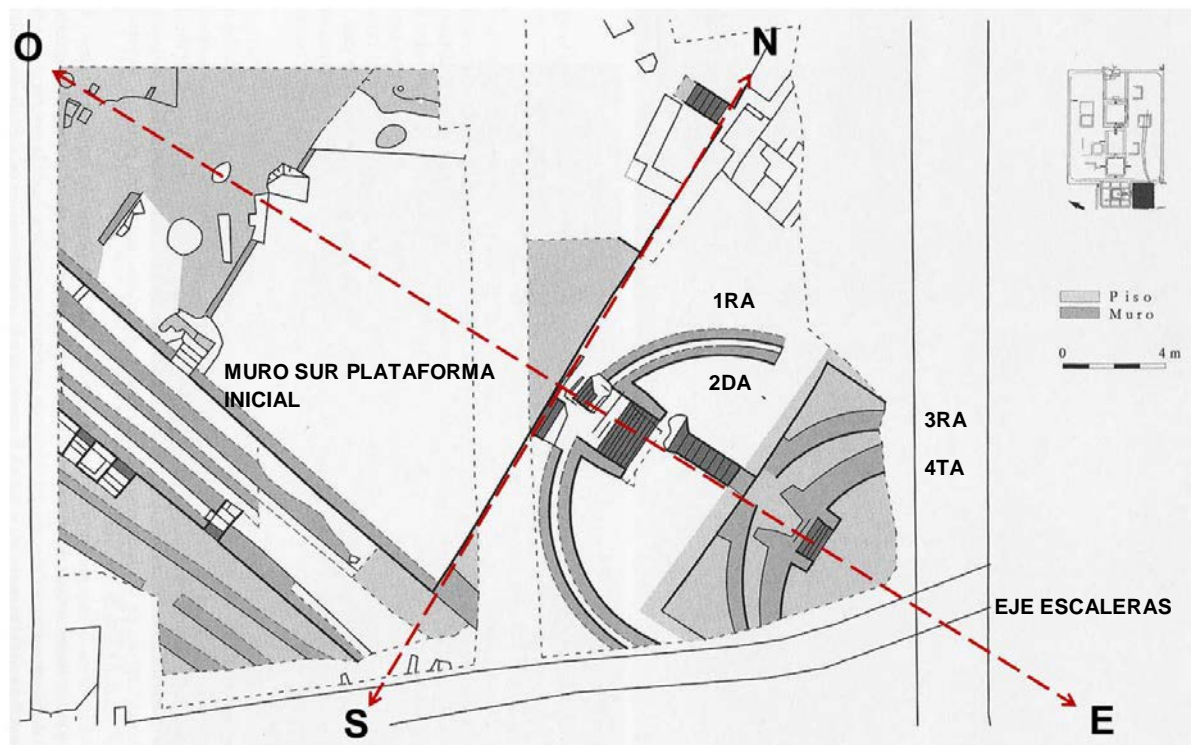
1er edificio. Ejes de orientación y elementos principales.
